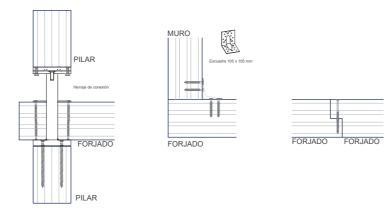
Uniones entre elementos estructurales. Elaboración propia
